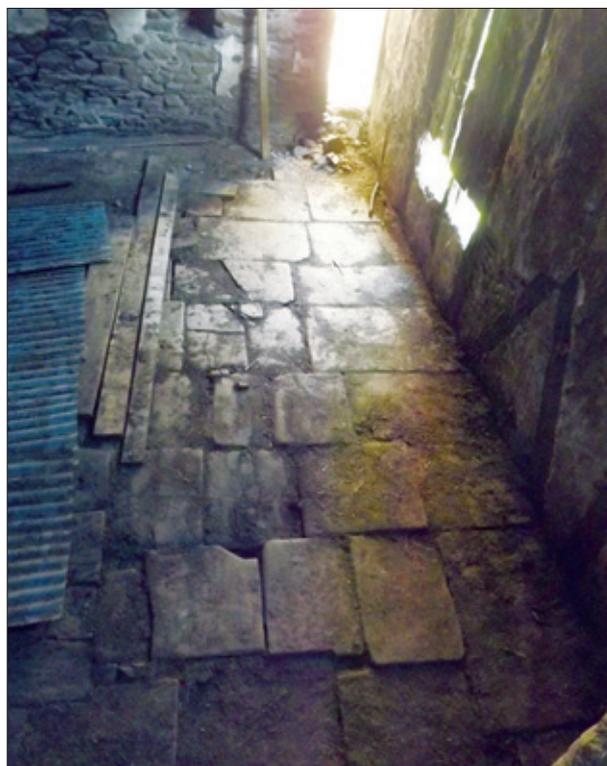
VESTIGES DES DALLES DE CALCAIRE recouvrant le plancher de la salle. *Cliché M. Scellès.
